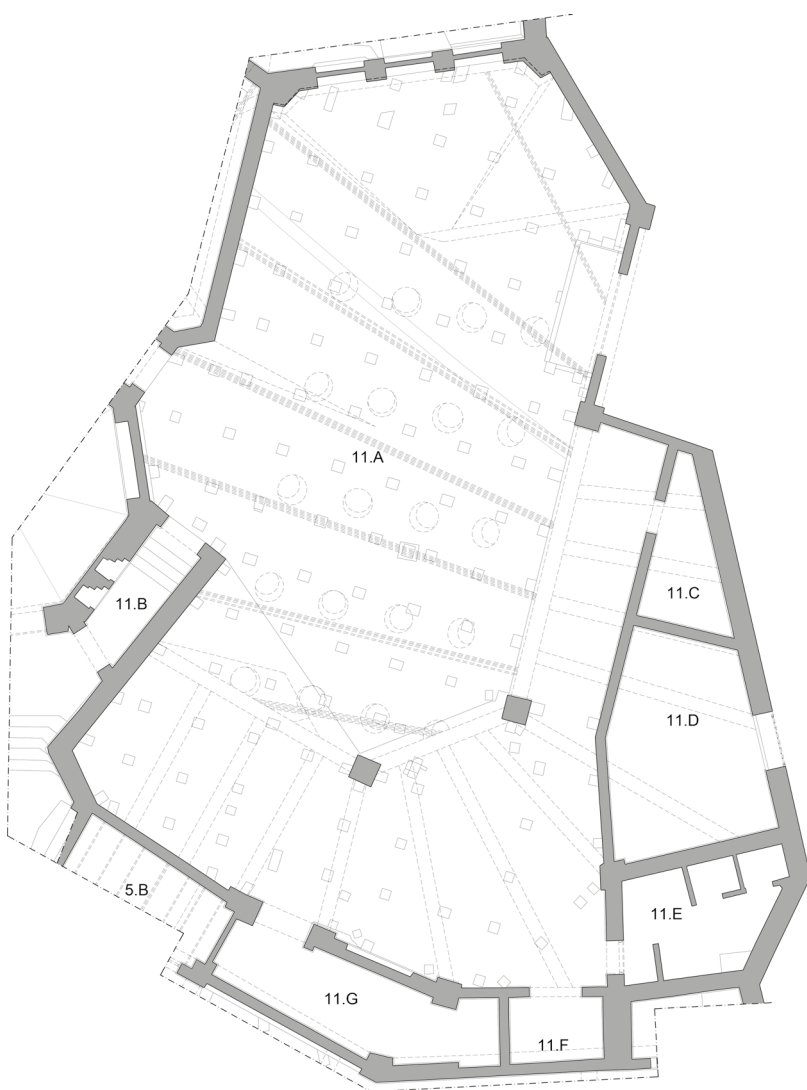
| Planta del bloque 11 (escala original de representación 1:50). | Planta del blocco 11 (scala originaria di rappresentazione 1:50).
